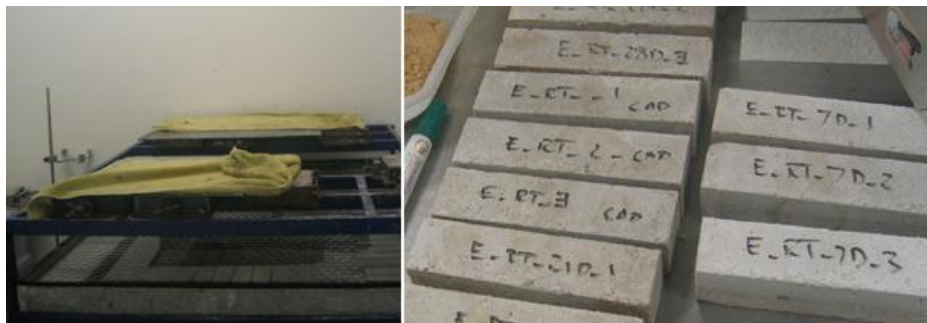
a) Colocação na câmara de cura b) Provetes após desmoldagem
